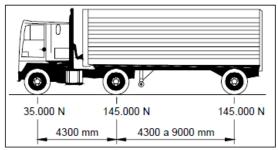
Vista de perfil del vehiculo de diseño. (AASHTO, 2005)
